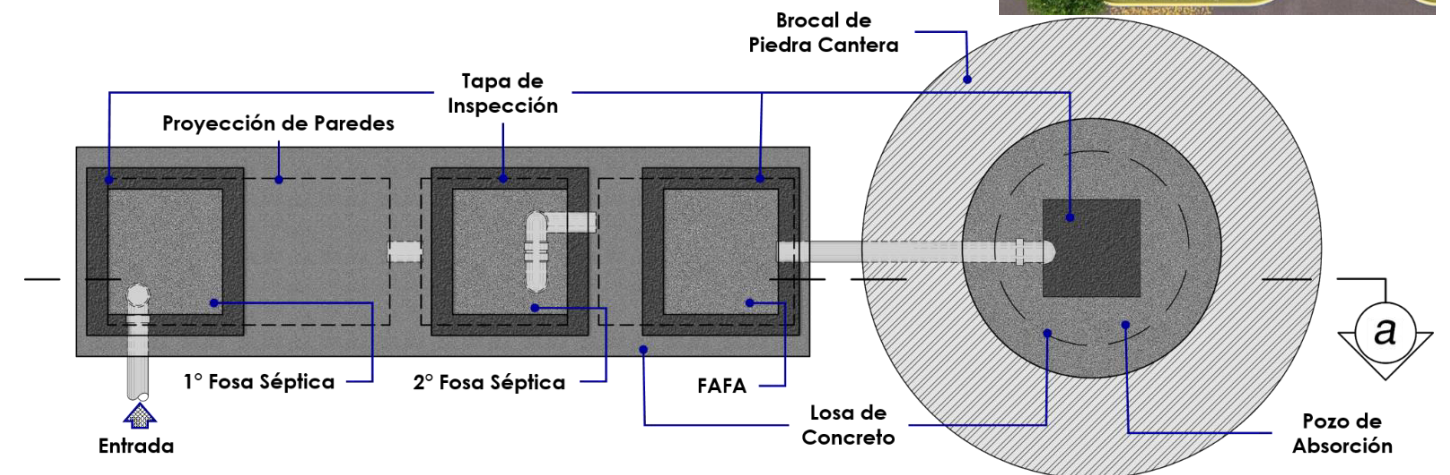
Planta de tratamiento de aguas negras, vista en planta
